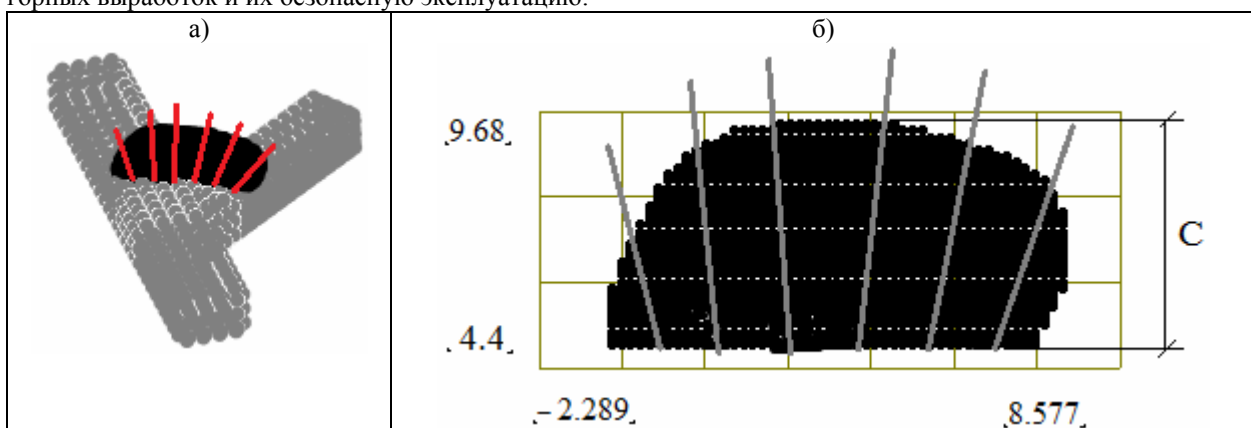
Схема армирования канатными анкерами кровли в самом широком месте сопряжения ствола со штреком на шахте Южная
